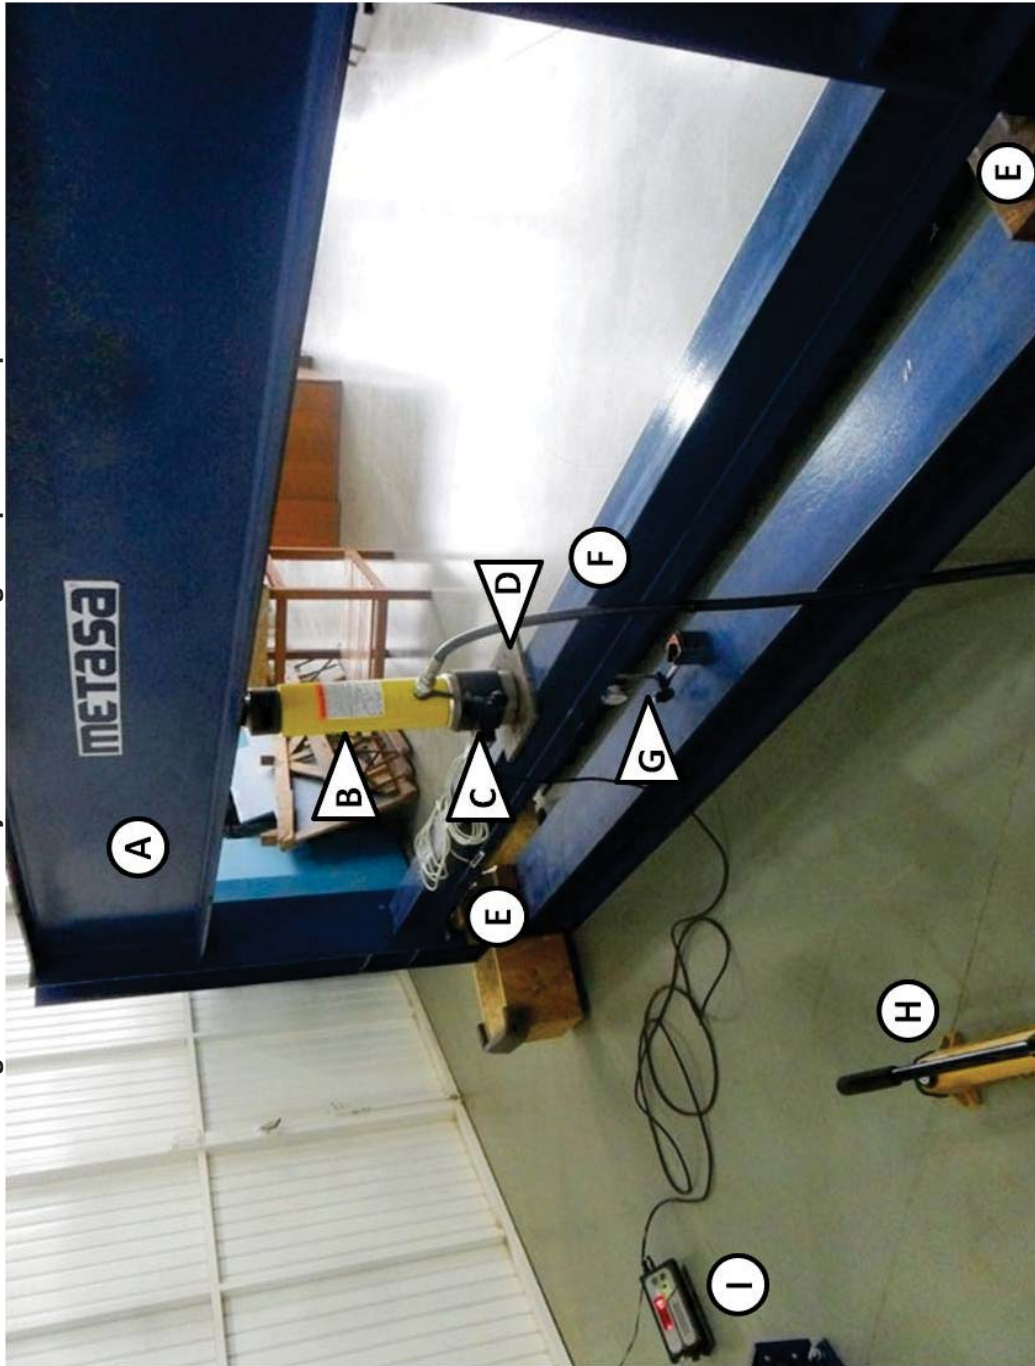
Ensaio de viga simplesmente apoiada: detalhes.
